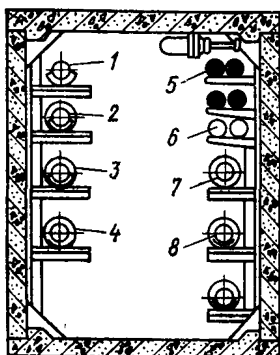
Схема размещения трубопроводов водоснабжения из пластмассовых труб в туннеле
